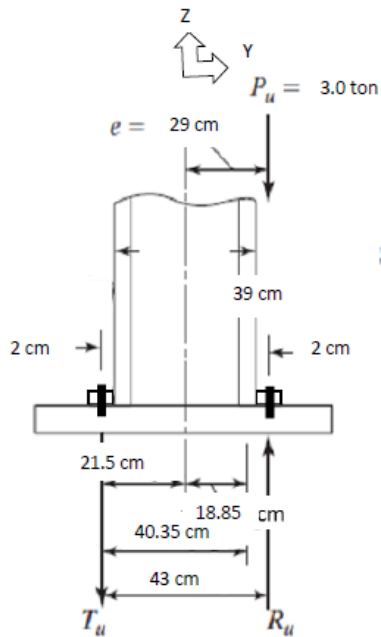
Ubicación de las fuerzas de compresión y tensión sobre la plancha
